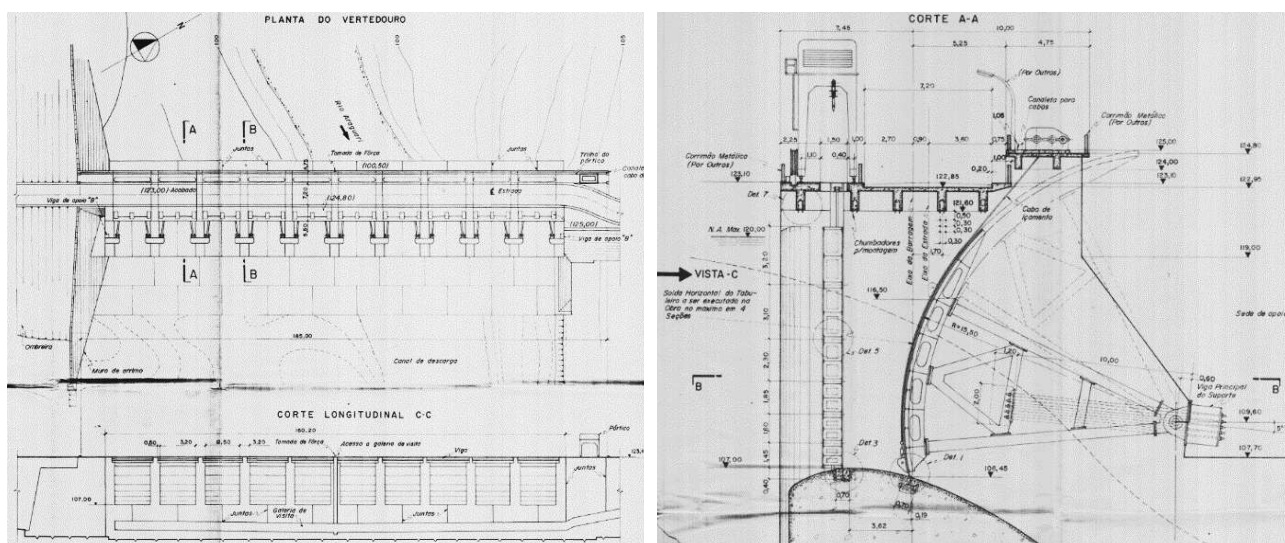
Vistas em planta, de montante e perfil típico do Vertedouro (cotas não referenciadas à rede do IBGE).
